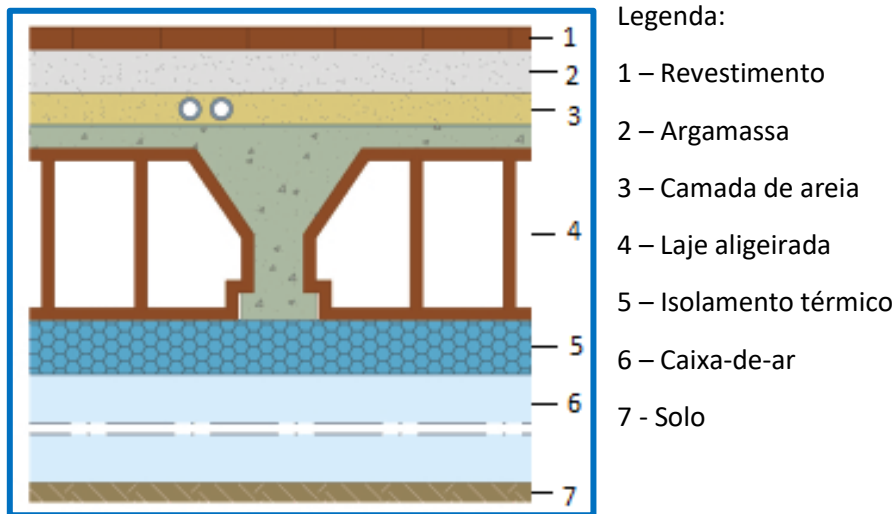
Pormenor da composição de um pavimento em contacto com o exterior
